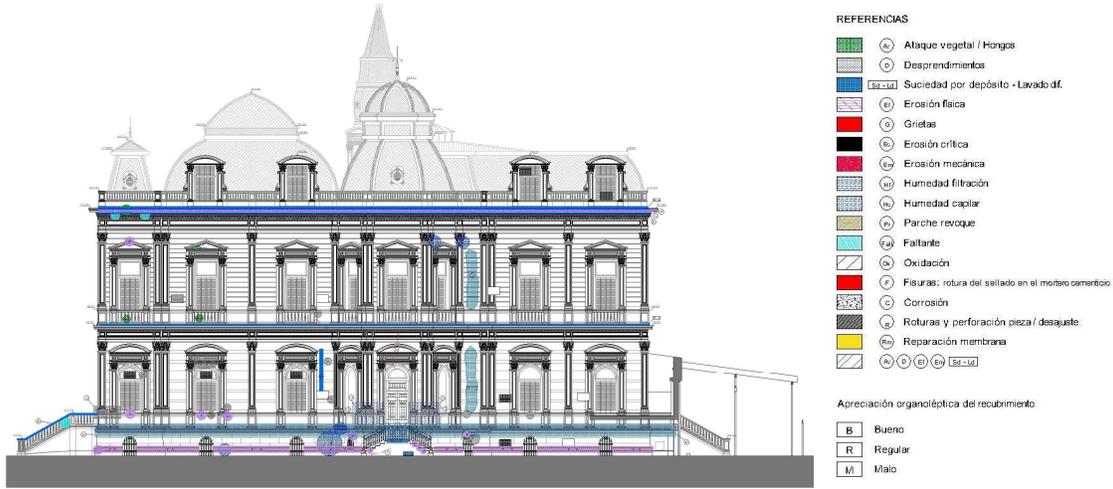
Alzado Fachada Sur (Estado Inicial 2007)
